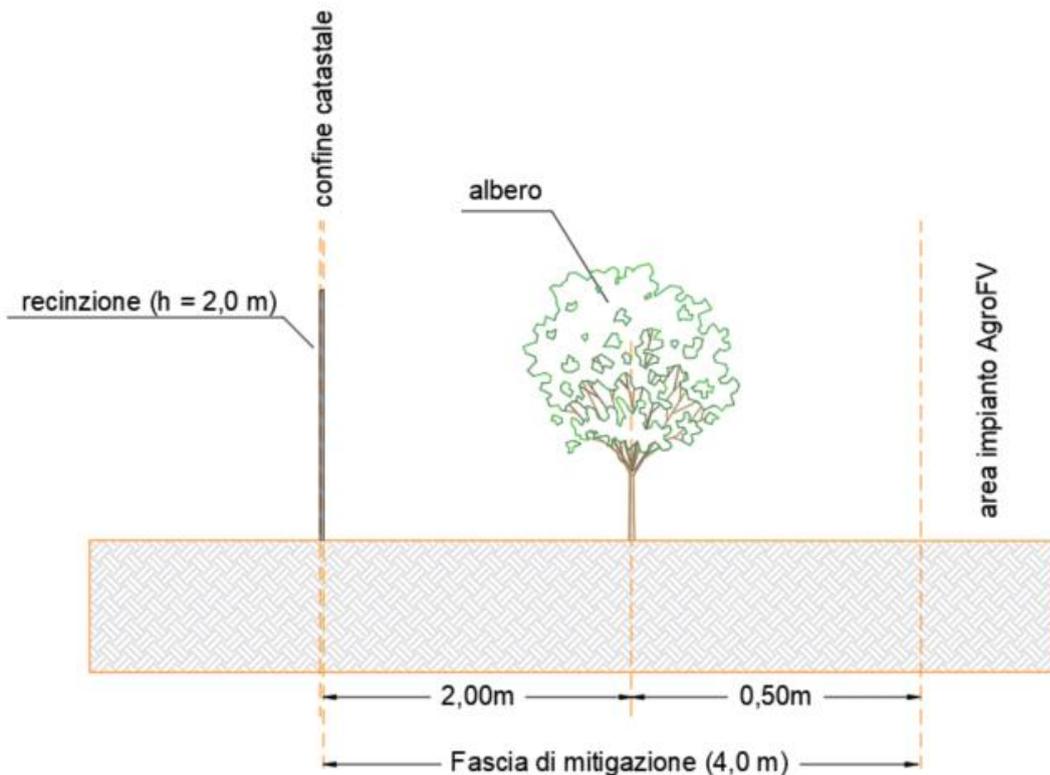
Stralcio di sezione dell'area dell'impianto.
